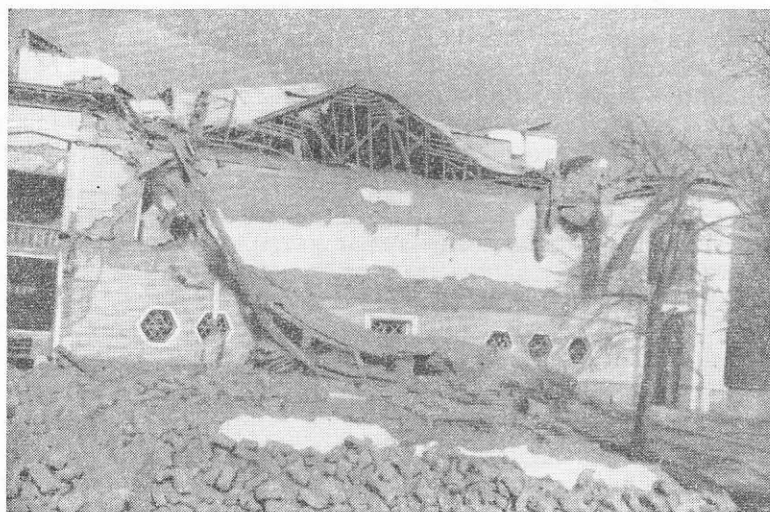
Полное обрушение наружной галереи с железобетонным перекрытием со стороны главного фасада
